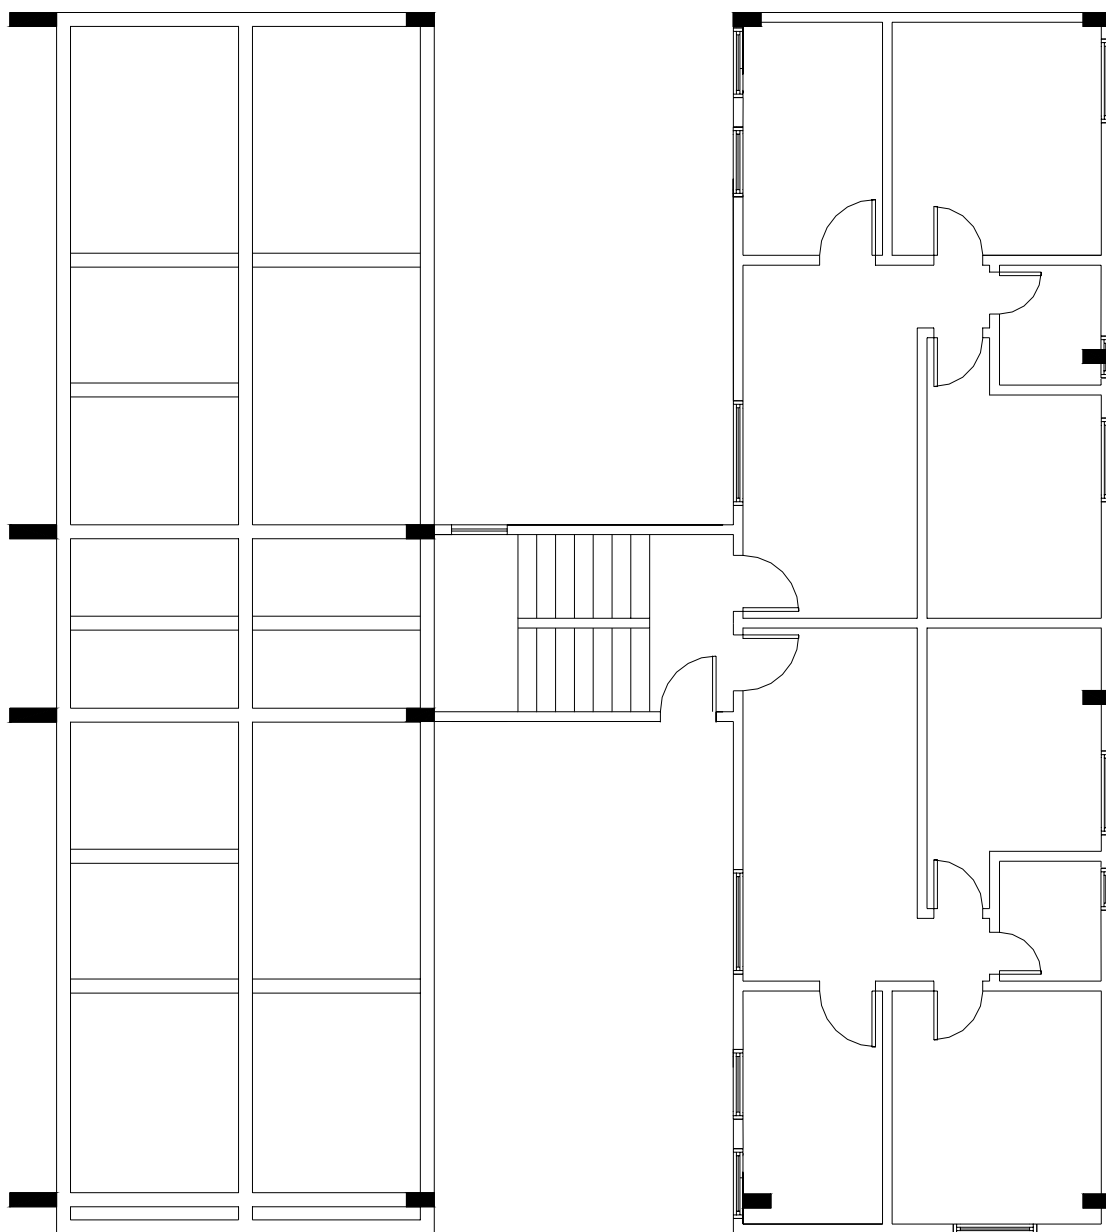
Residencial “J” – Bloco 4 – Segunda solução de vigamento de pilotis
